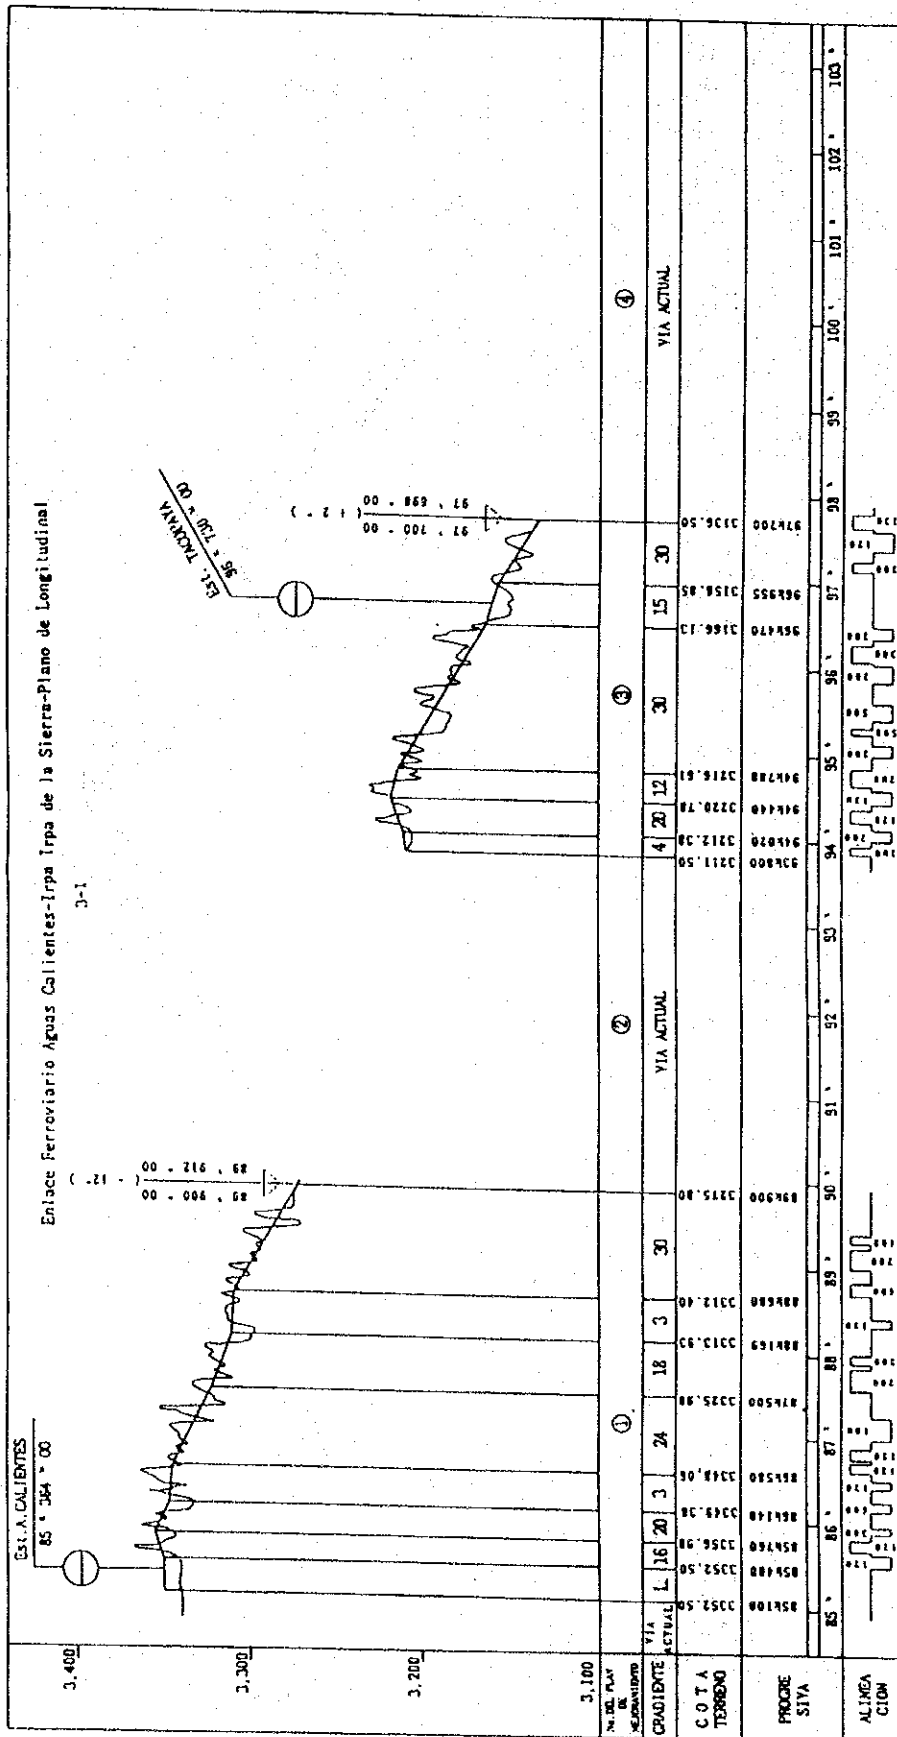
Perfil de Via del Plan de Mejoramiento de la Ferrovía Oruro-Cochabamba; Plano 1 de 3
